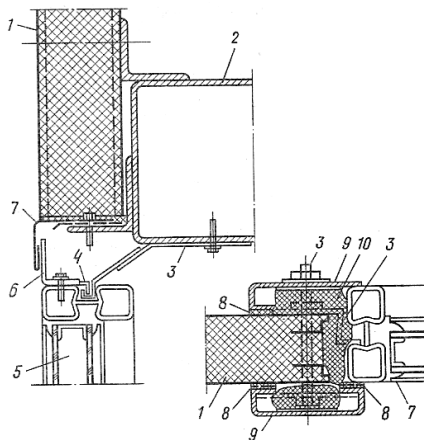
Сопряжение стальных переплетов со стенами:
